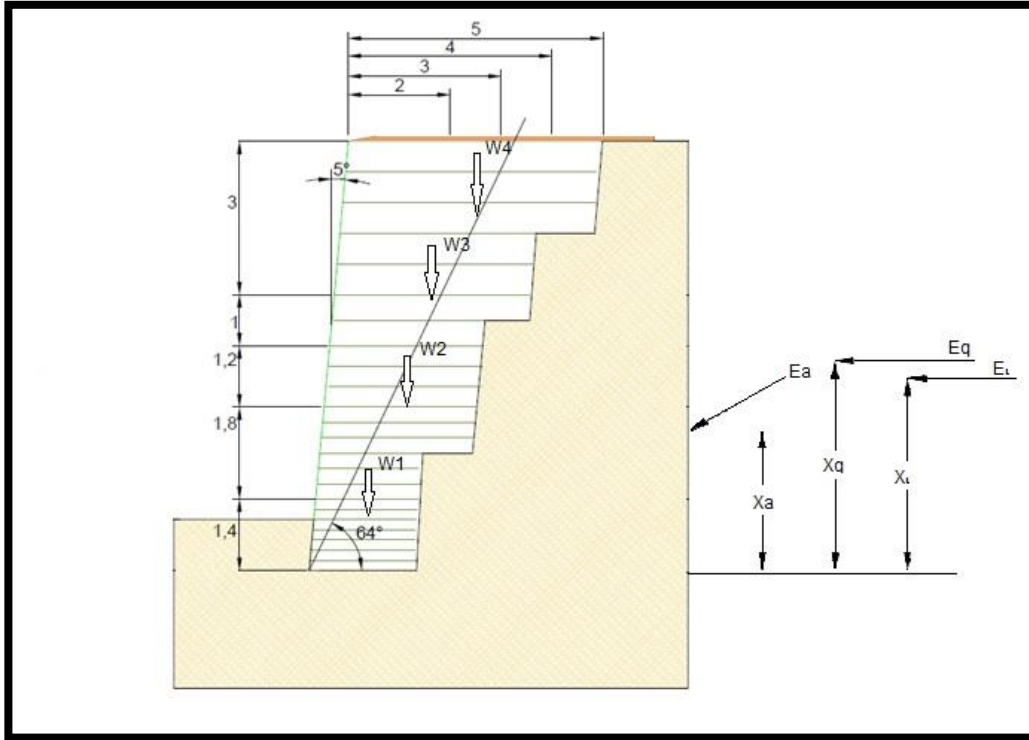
Fuerzas que actúan en un muro reforzado con georillas
